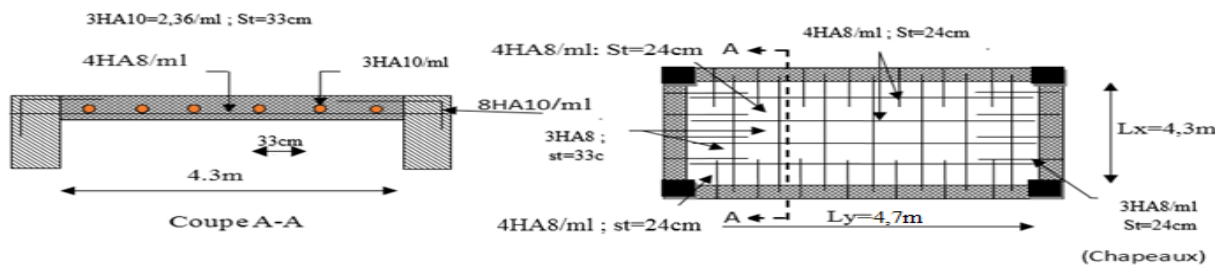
Schéma de ferrailage de la dalle sur 3 appuis (balcon)
